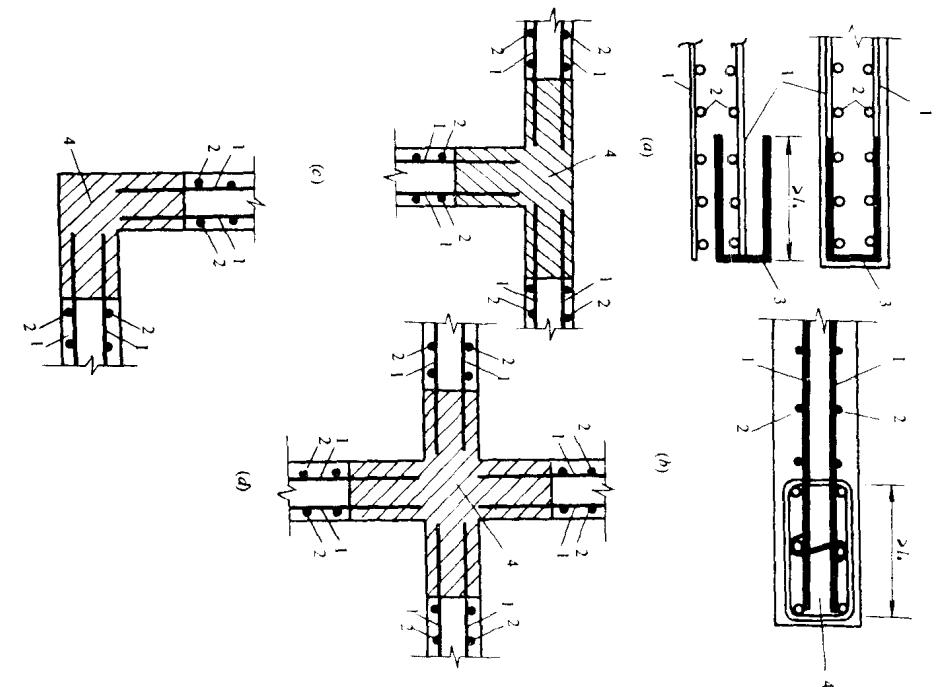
钢筋焊接网在墙体端部的构造
